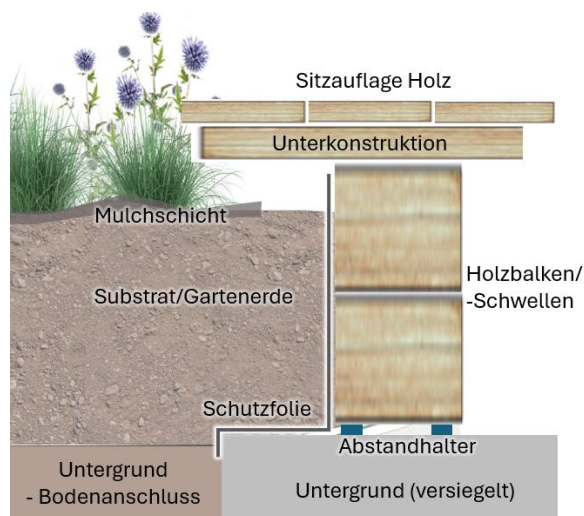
Aufbau Pflanzfläche mit Bodenanschluss, Holzbalken/Schwellen und Sitzauflage aus Holz
